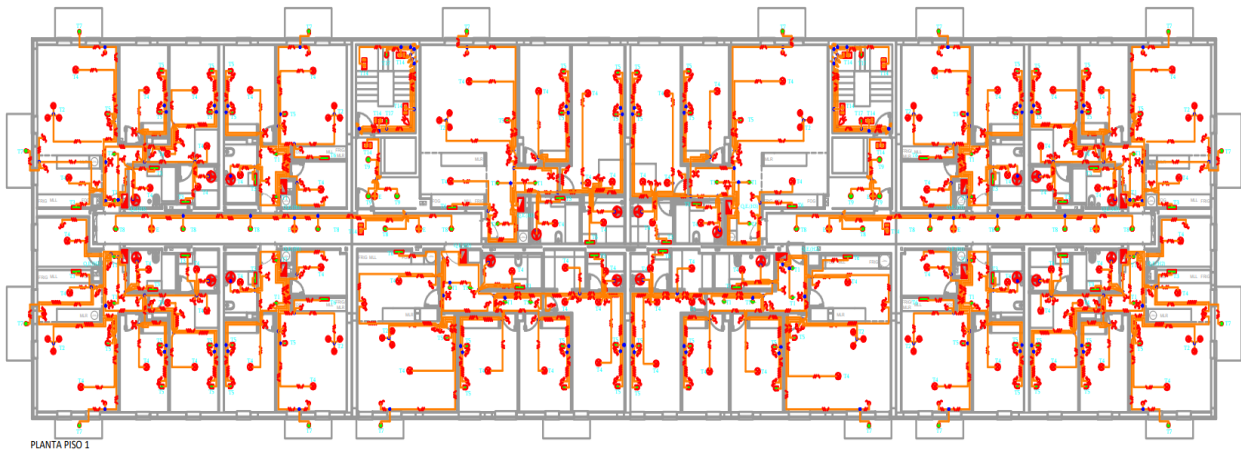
Projeto eletricidade - iluminação piso 1.
